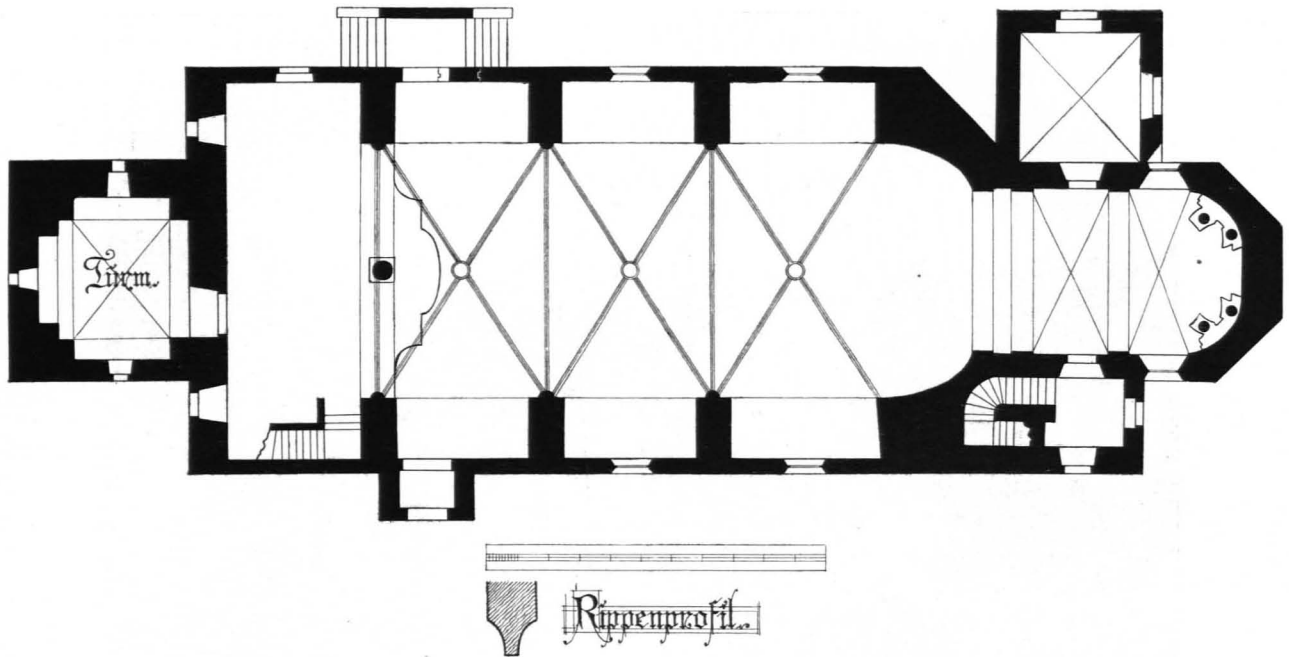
Drosendorf, Stadtkirche, Grundriß 1 : 250 (S 156)
